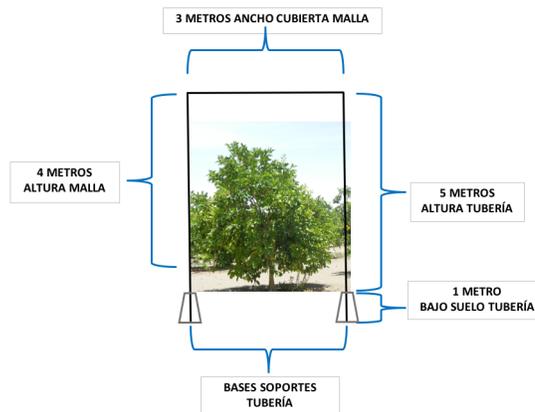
Diseño estructura proyecto Mallas limón de Pica
